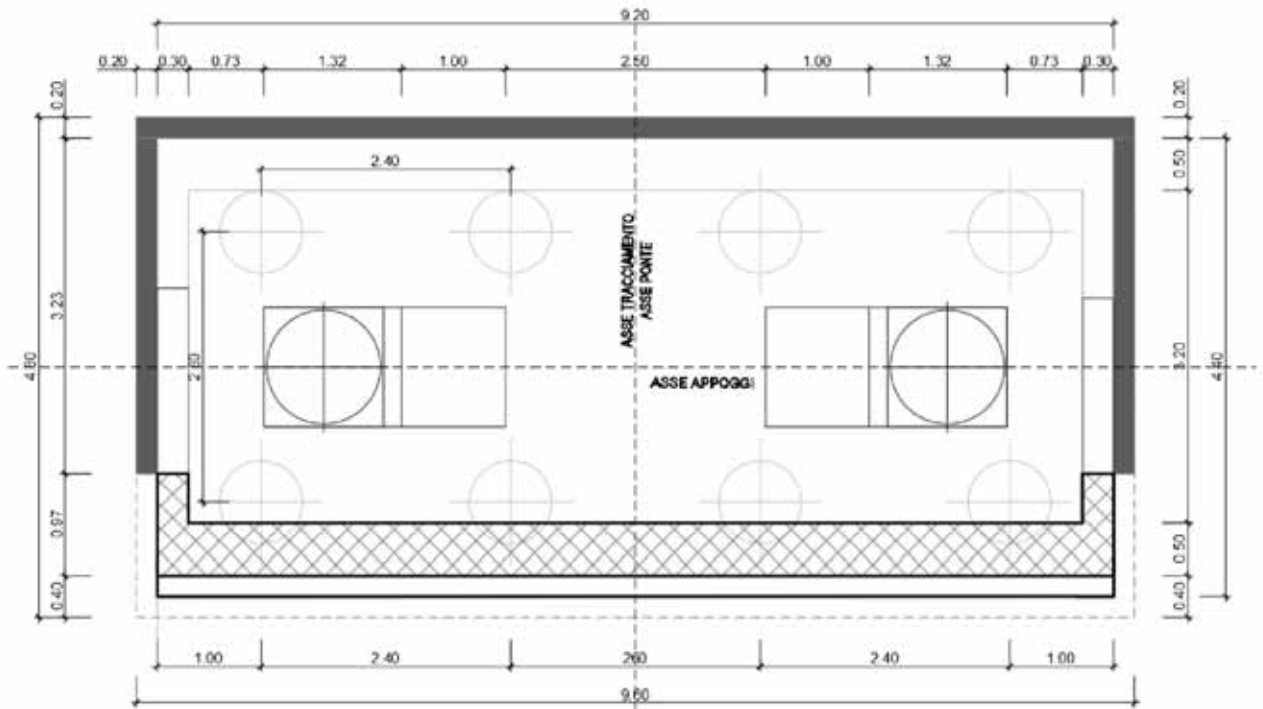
Pianta fondazione spalla Sx e della spalla Dx
